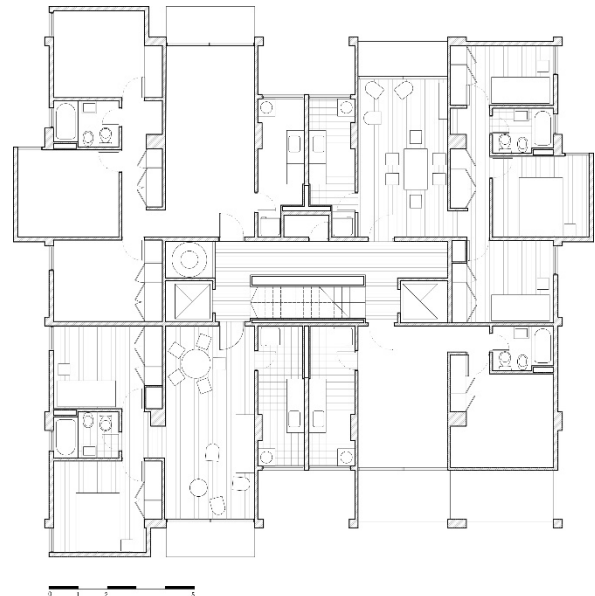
Conjunto Rioja. Planta tipo torres n° 1, 3, 5 y 7. Elaboración del autor.
